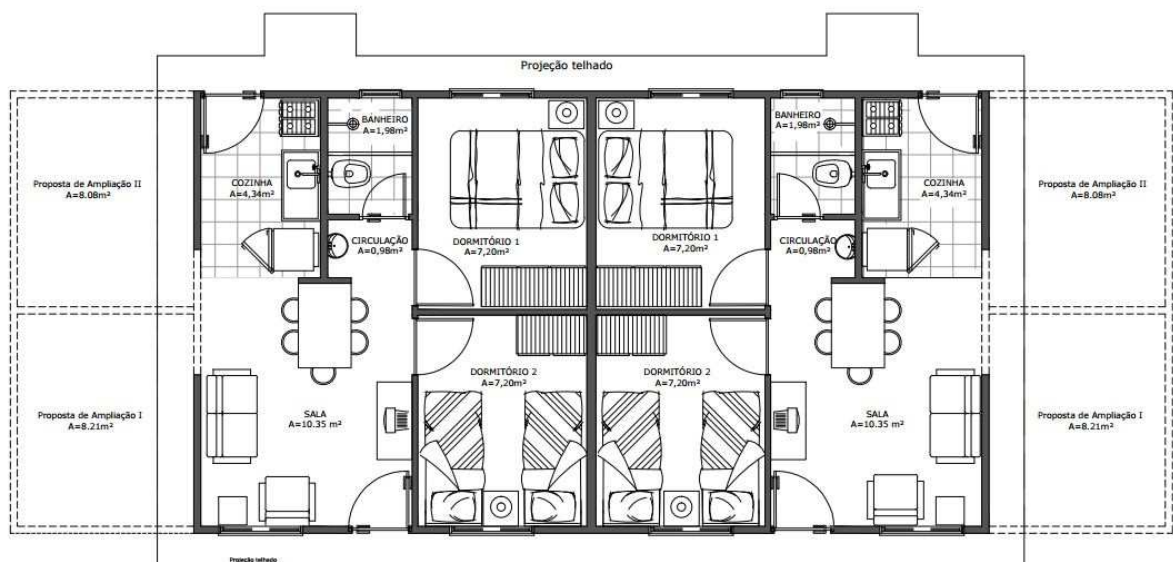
Planta Baixa original, unidade geminada Loteamento Zilda Arns.
